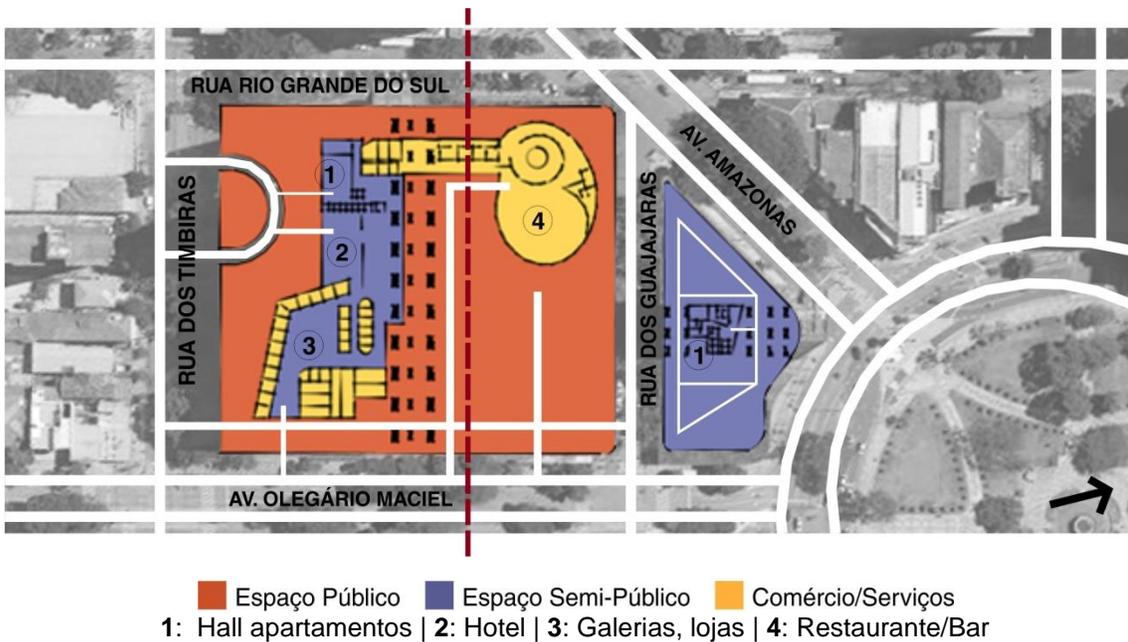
| Conjunto JK - Planta térreo, nível 02 | Desenho da Autora
